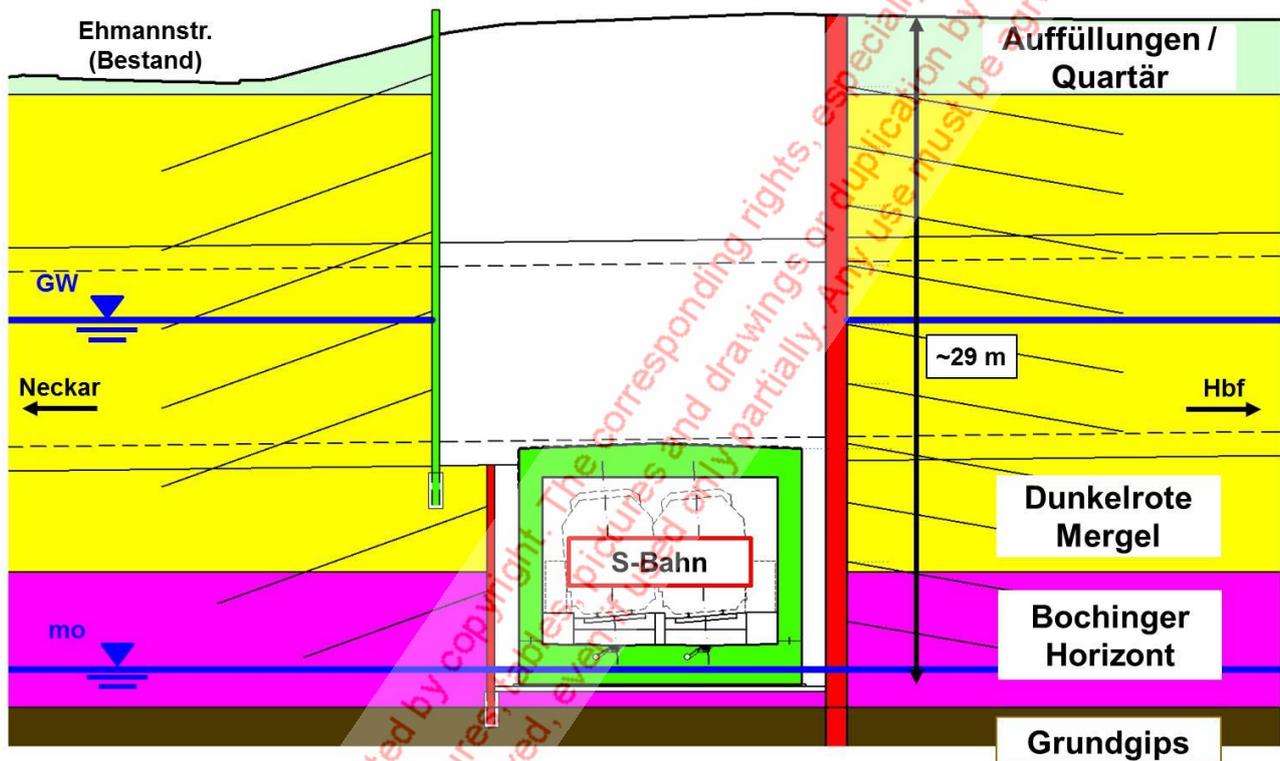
Schnitt 1-1, Baugrube S-Bahn
